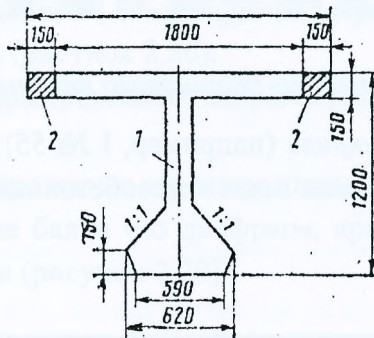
Поперечное сечение элемента пролетного строения из унифицированных балок 1 – унифицированная балка; 2 – бетон омоноличивания.
